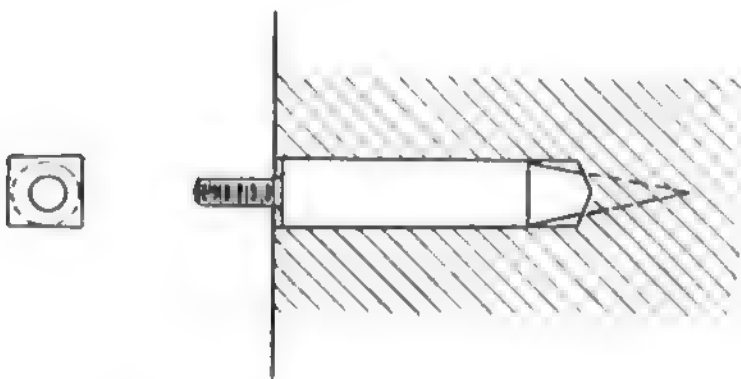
Bei Eisenbeton-Mauerwerk werden die Stahldübel in ein rundes, vorgebohrtes Loch eingetrieben.
